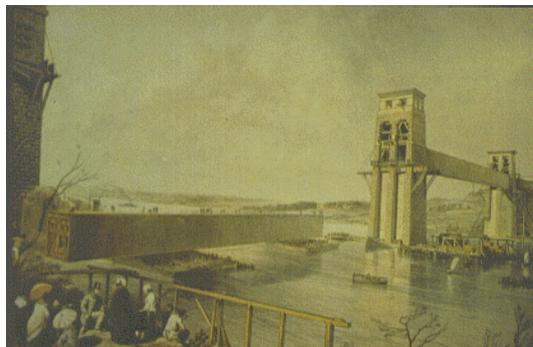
Ponte Britânia: duas vigas caixão com ferrovia interna.
